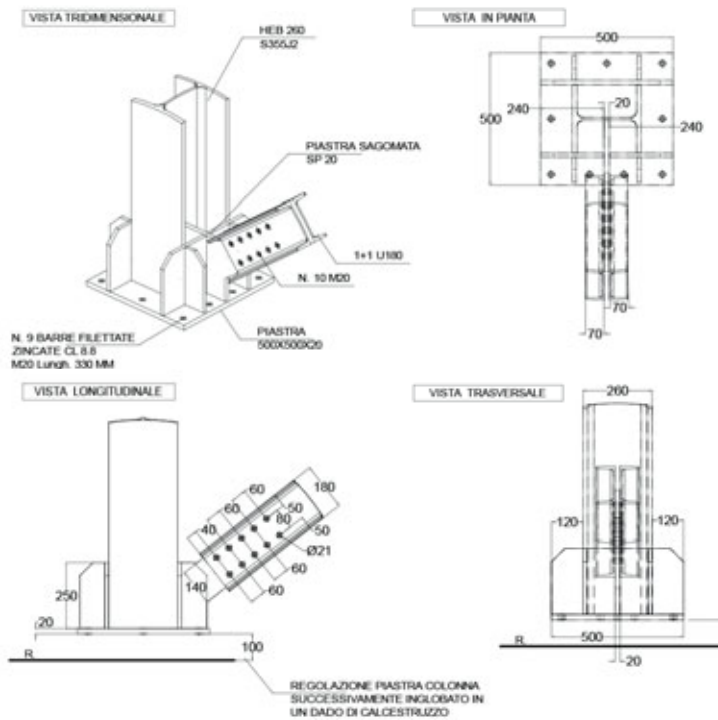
Dettaglio costruttivo della connessione del controvento al piede del pilastro. © Carpenteria S.A.C.I.F. Srl
